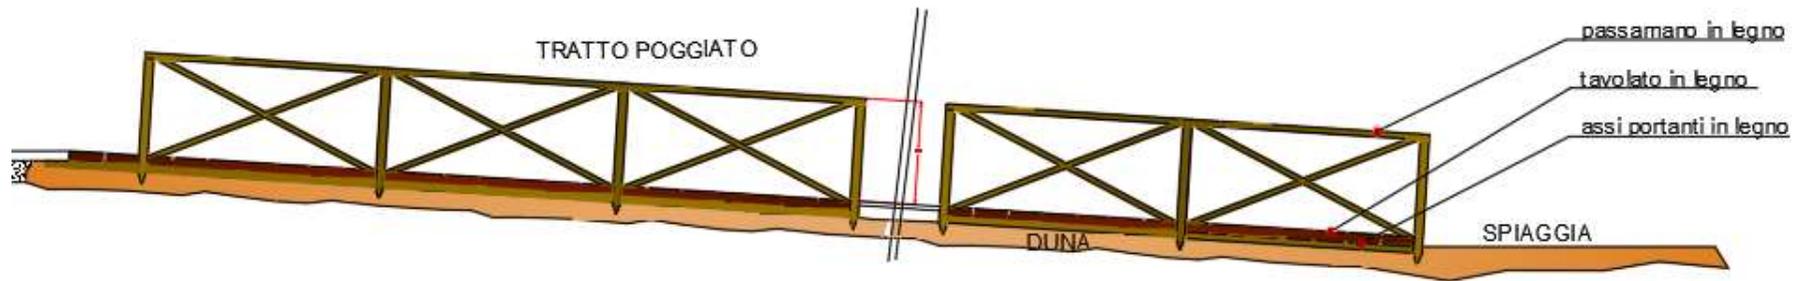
Prospetto tipo per accesso al mare n. 29
